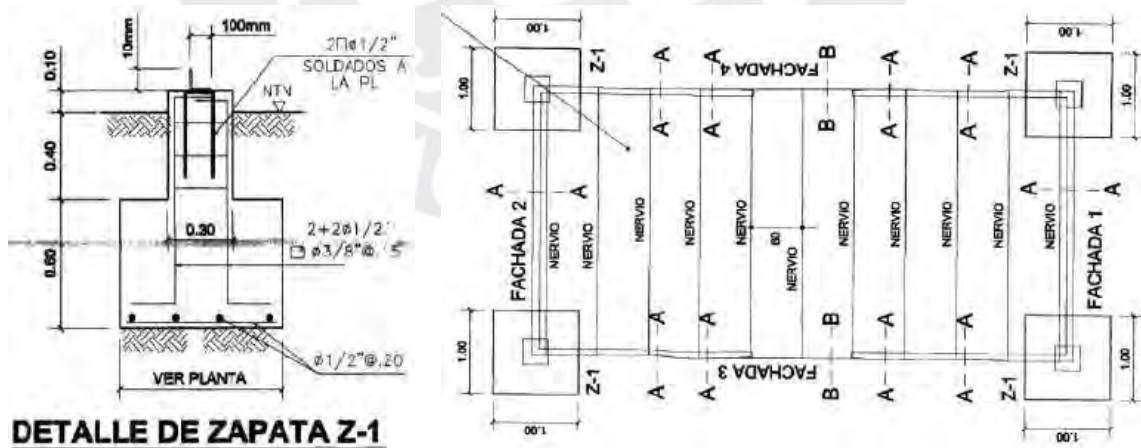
Detalle de zapata aislada Z-1 – Planos
